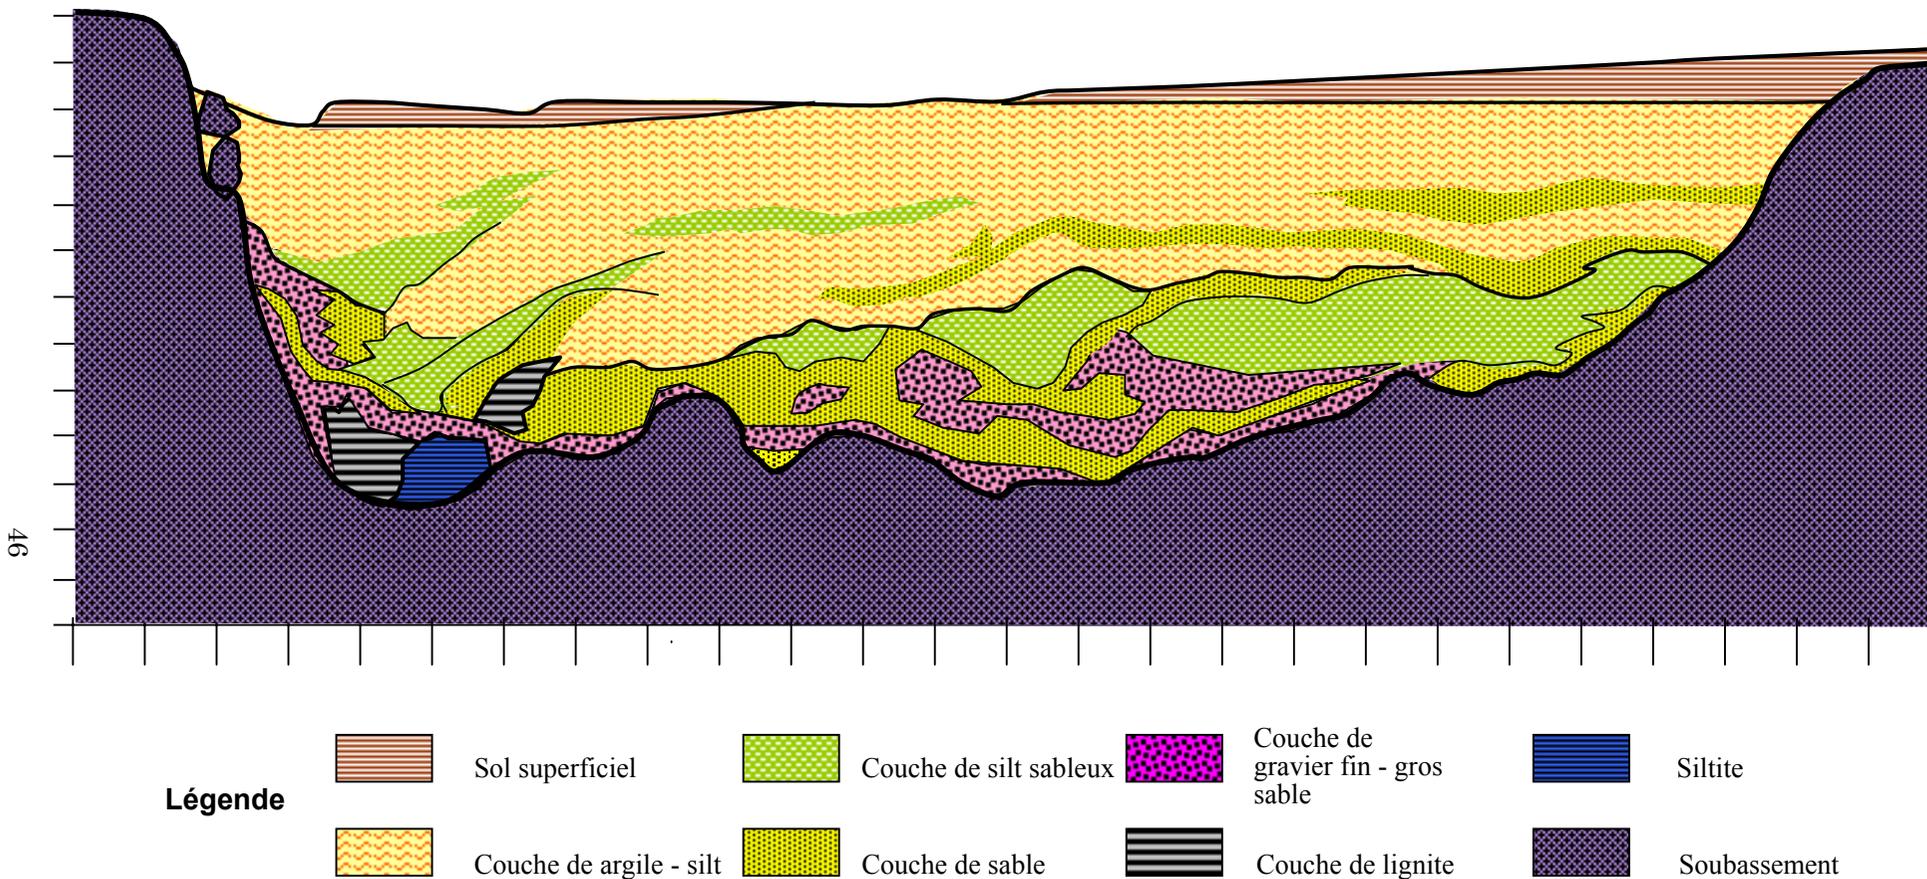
Profil géologique de la «vallée fossile» au site du barrage souterrain (profil excavé en amont)
